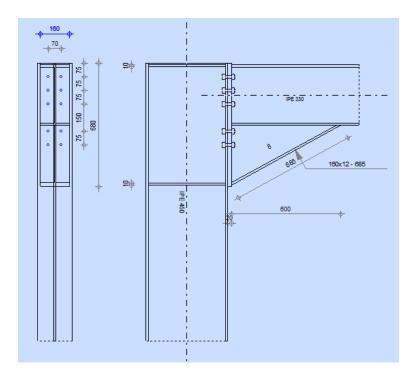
Schéma d'assemblage (poteau-poutre maitresse)
